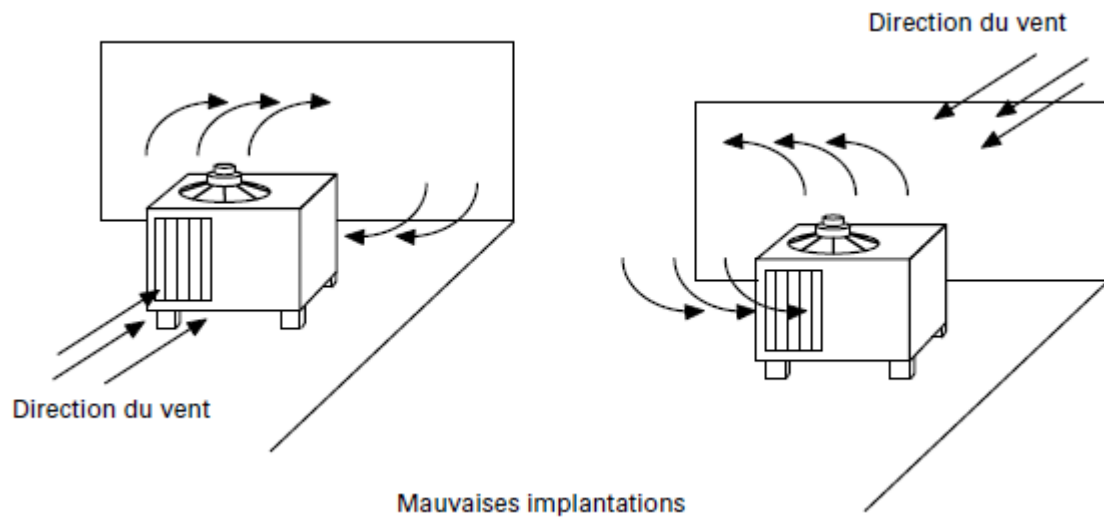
Recyclage parasite d'air extérieur sur la pompe à chaleur
